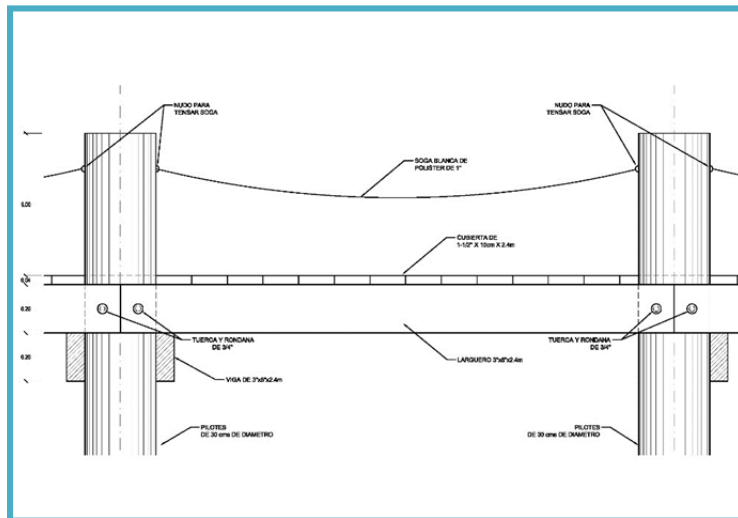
Detalle de la sección longitudinal de los andadores.
